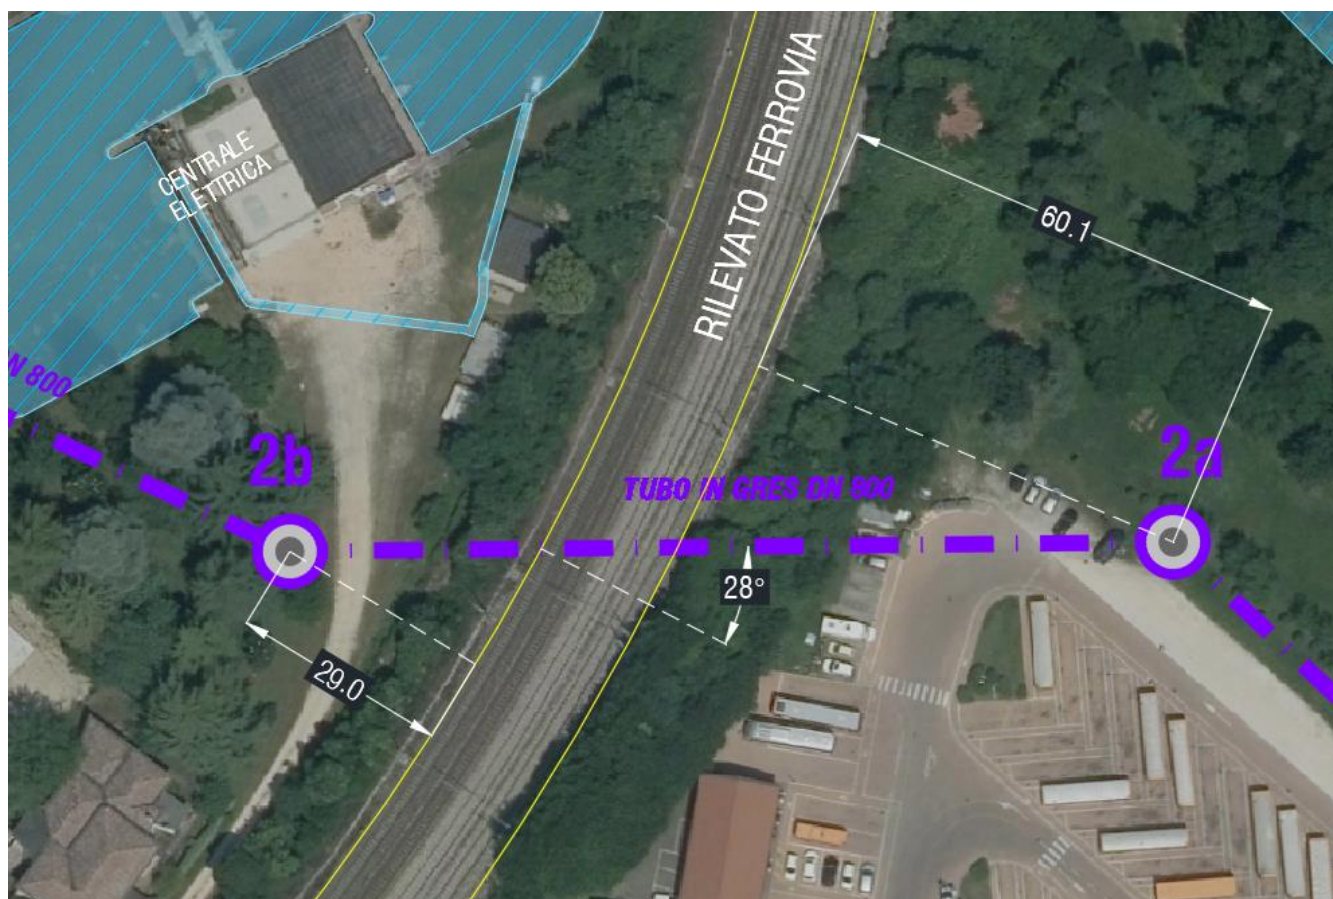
A : Estratto planimetrico posa condotta tratto 2a – 2b
